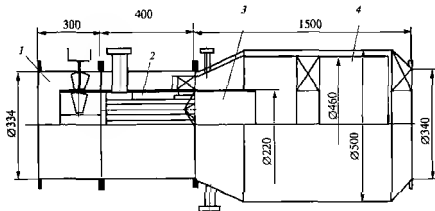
Газовоздушный калорифер ГВК-0,3:
